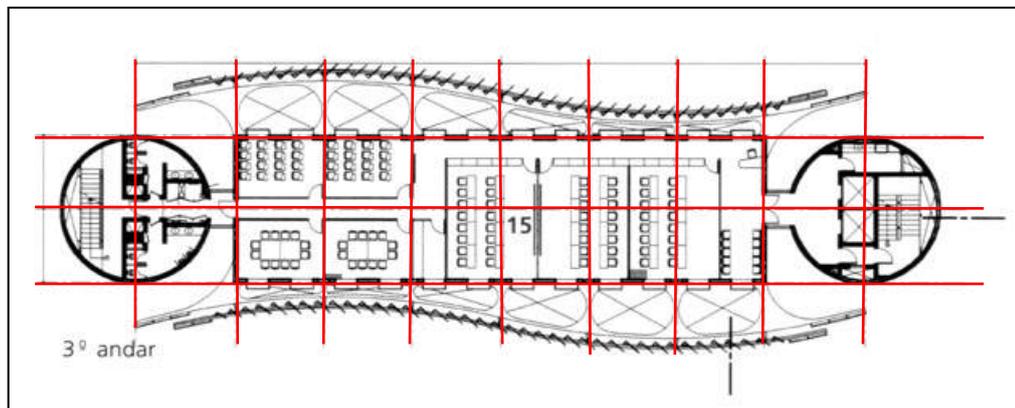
Planta nível sala de aulas – Malha estrutural
